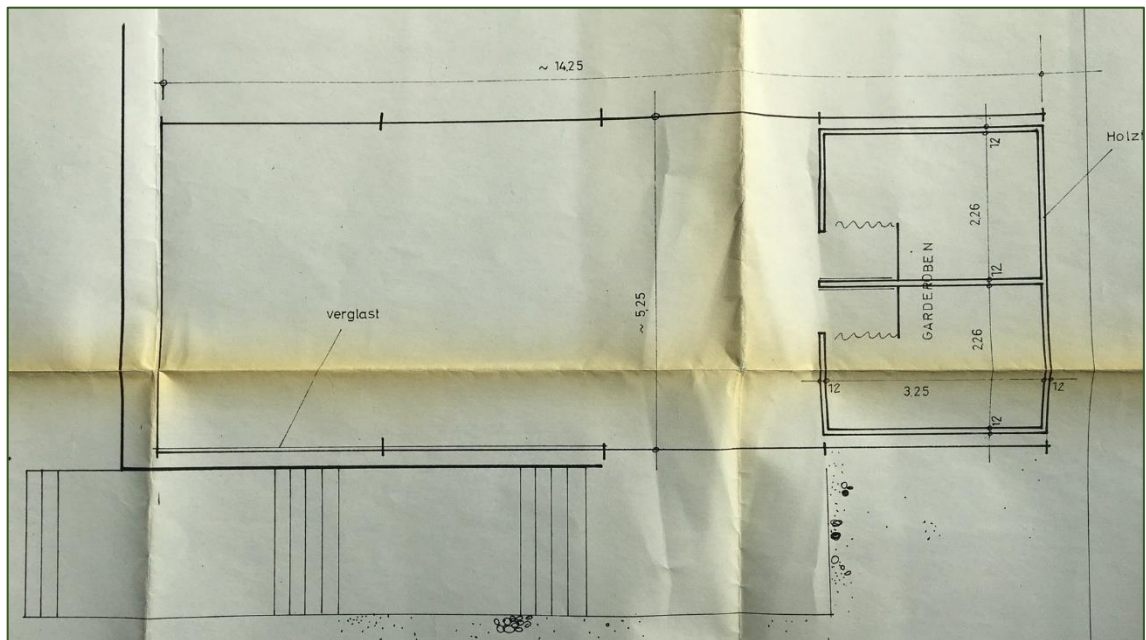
Pavillongrundriss, Entwurf Hochbauamt Mainz 05.04.1961; Ausschnitt
